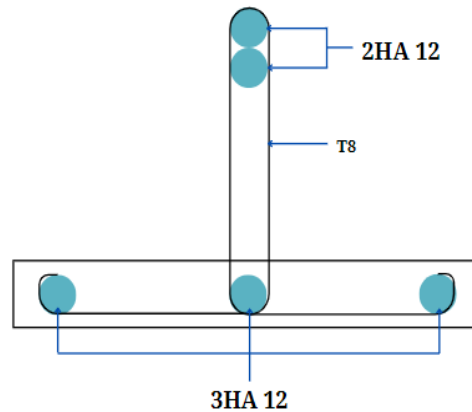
Schéma de ferrailage des poutrelles de type 1
